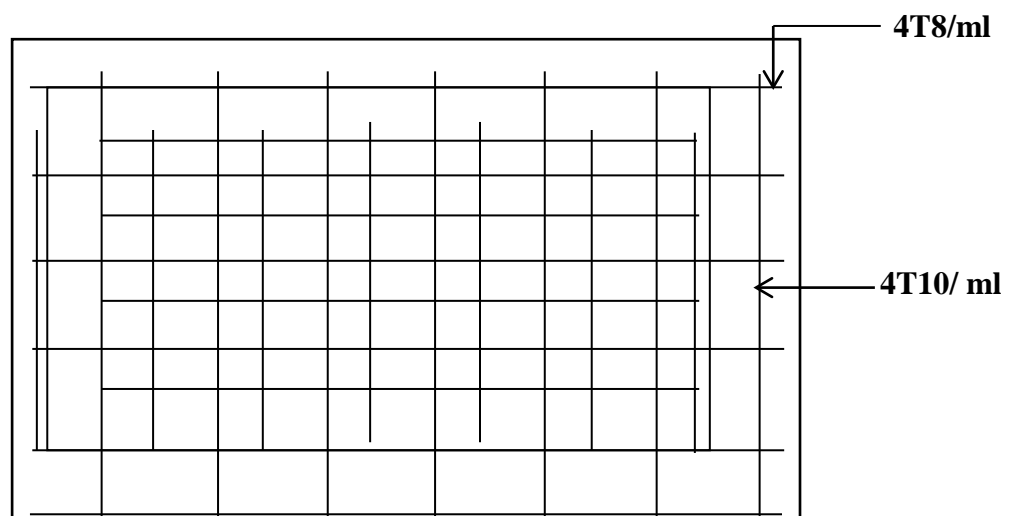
Ferrailage inférieur du panneau de dalle
